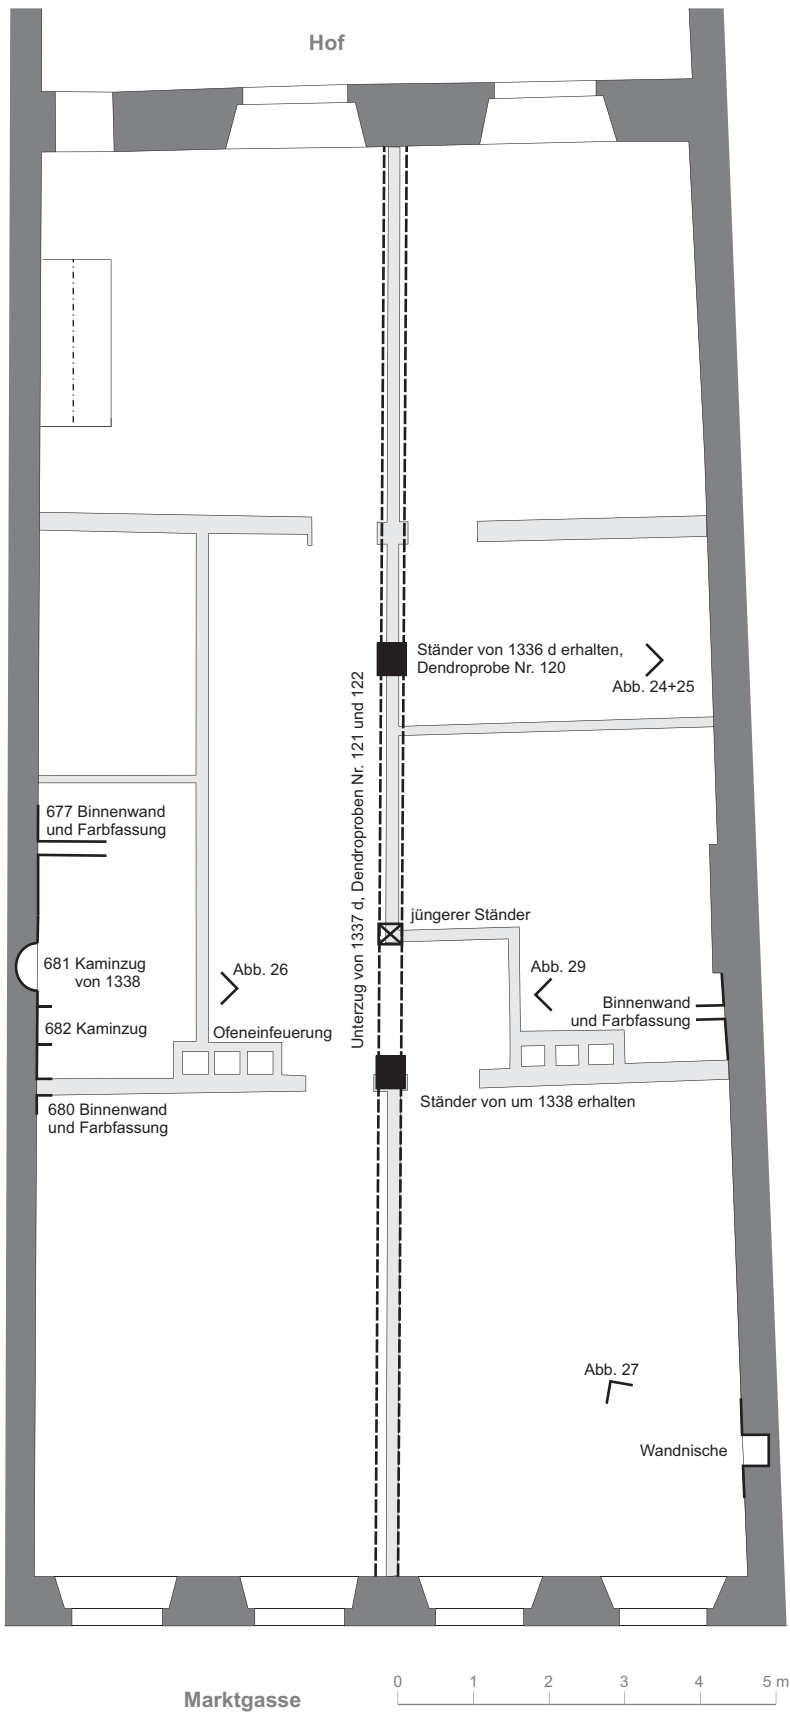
Winterthur. Marktgasse 44. Grundriss 2. Obergeschoss mit Graueintrag der jüngsten Binnenwände. M. 1:100.
